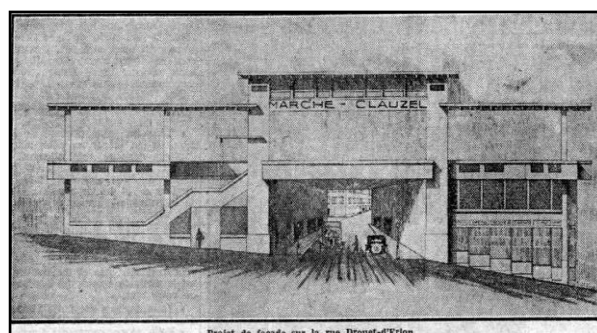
Façade sur la rue Drouet d'Erion du projet proposé
